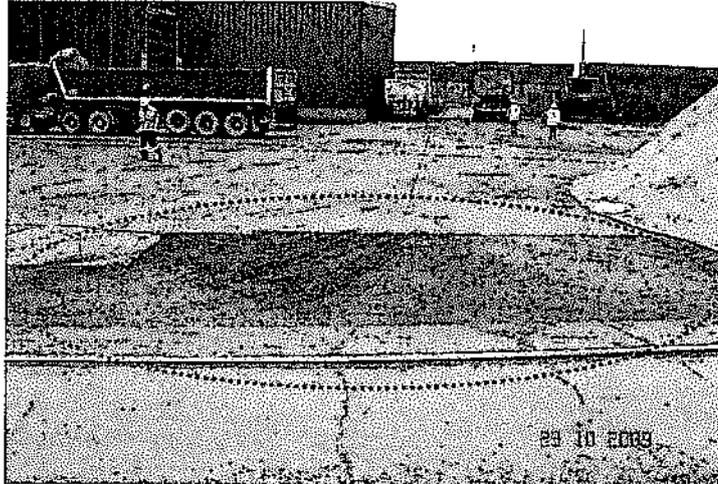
(Obs.1, 2009) : Losas deterioradas, con depresiones y rajaduras, cercanía a depósito de plomo.
